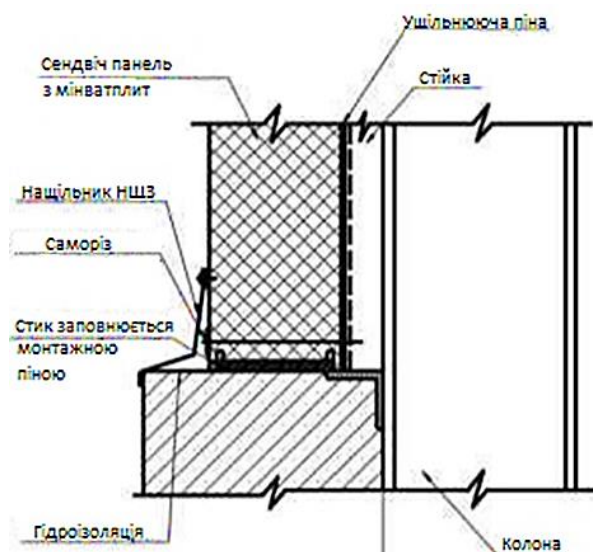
Опирання стінової сендвіч-панелі на цоколь будівлі
